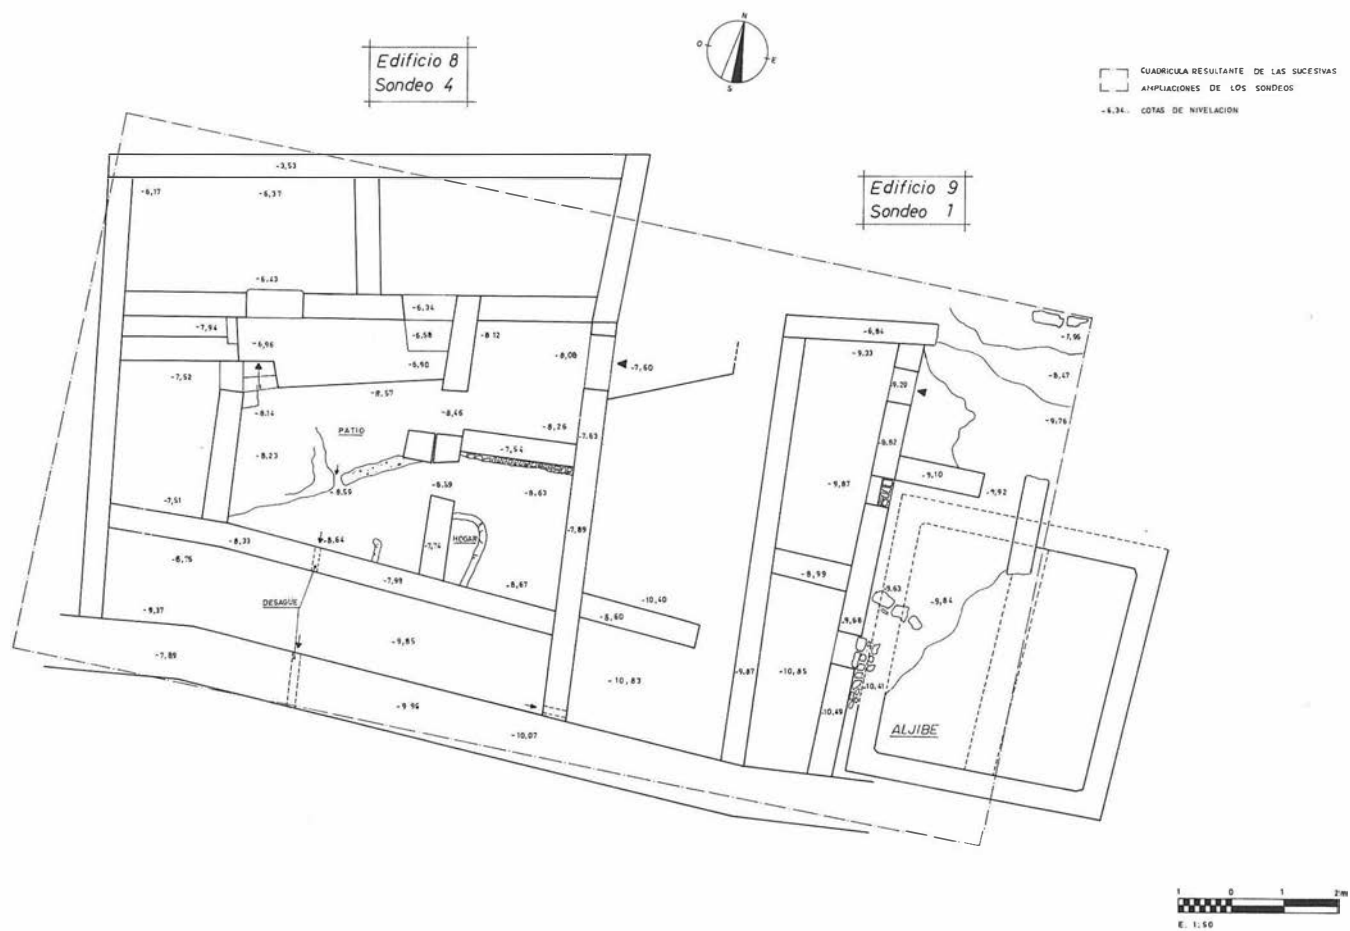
Planta de la casa núm. 8 (C-4) y del edificio (C-1).
